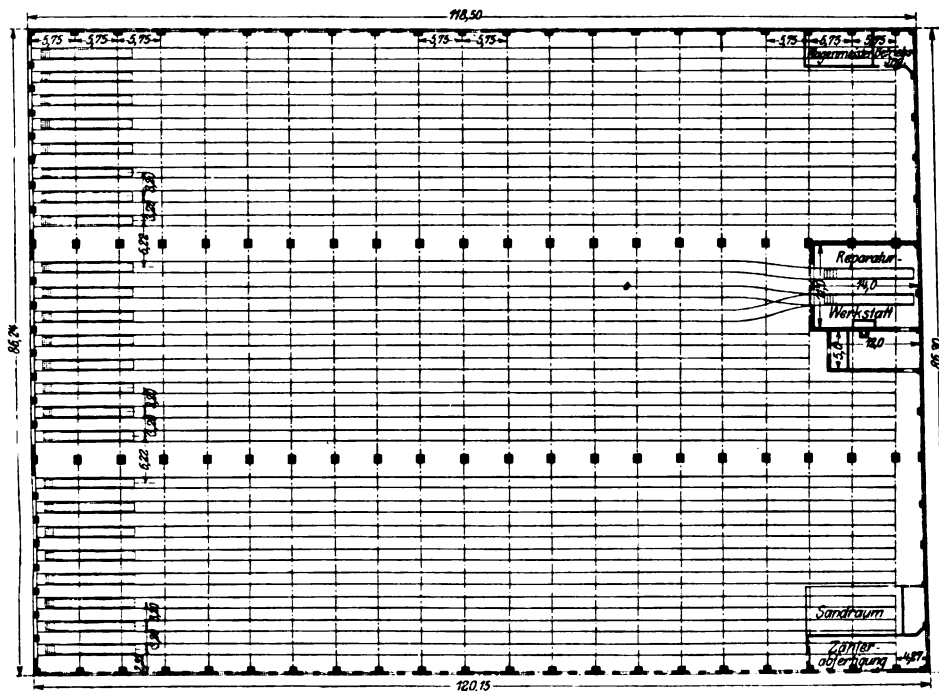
Wagenhallen auf Bahnhof Berlin-Schöneberg. Grundriß.
